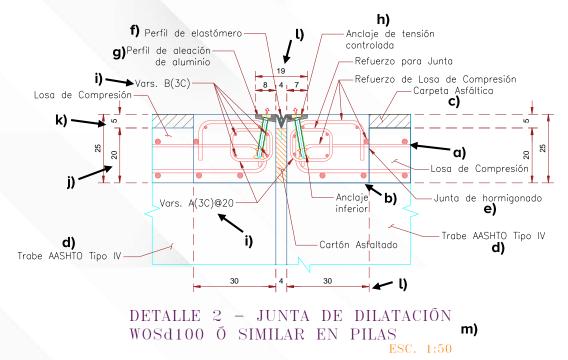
Ejemplo detalle 2, junta de dilatación en pilas
